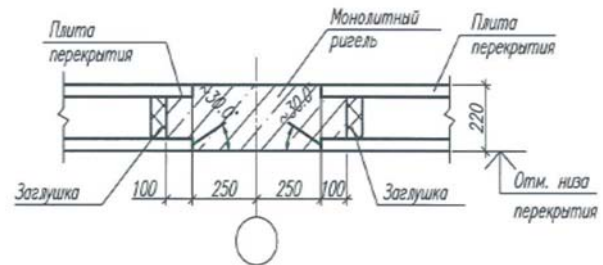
Схема з'єднання плит перекриття із ригелем / The scheme of connection of floor slabs with a bolt
